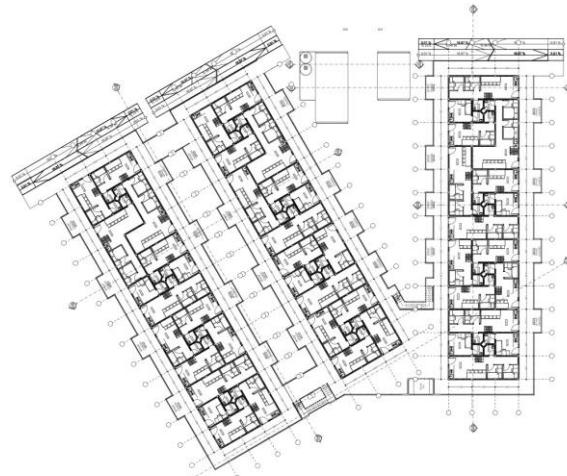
Rancangan Lantai 1 Bangunan
